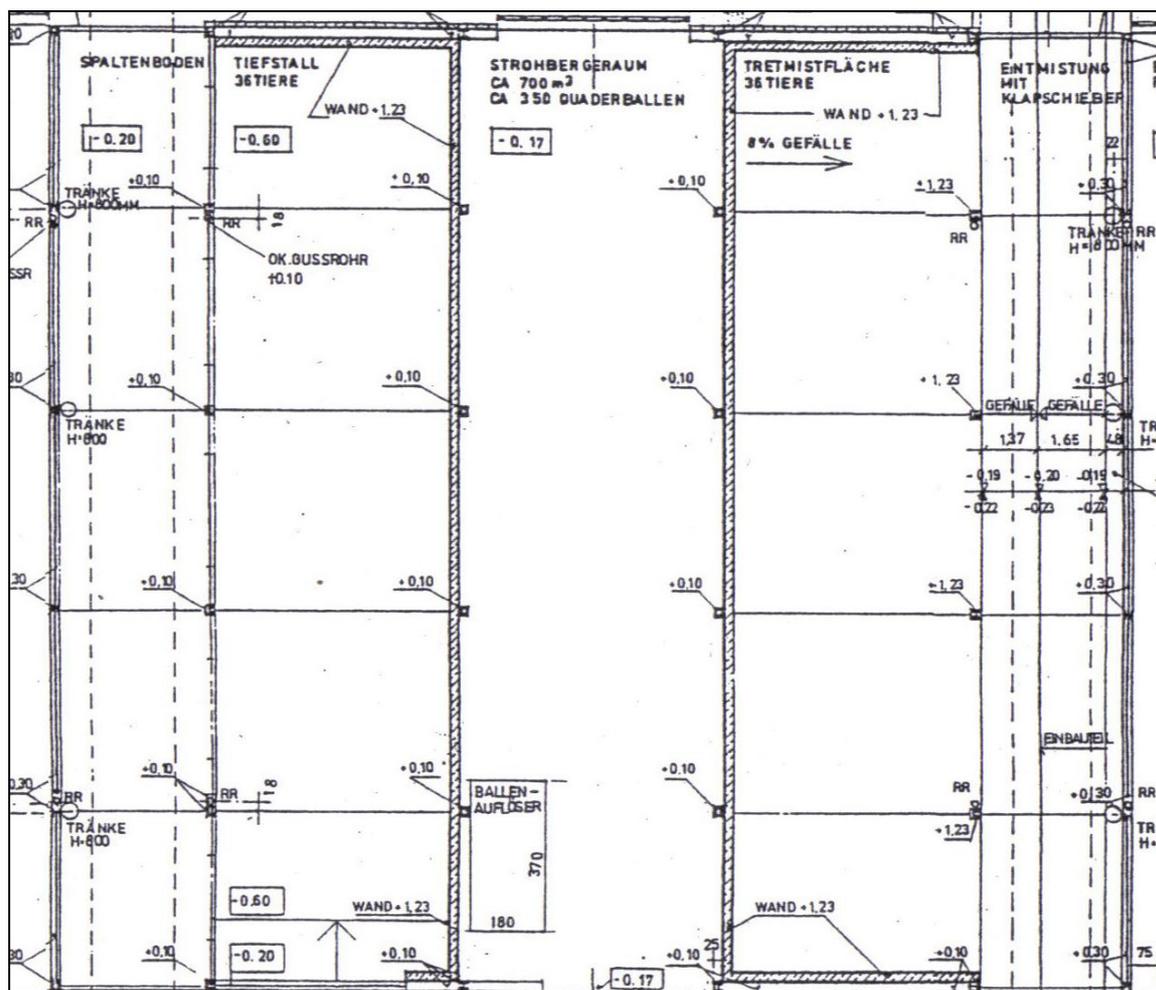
Grundriss des Tiefstreu- und Tretmiststalls mit Strohlager in der Mitte
